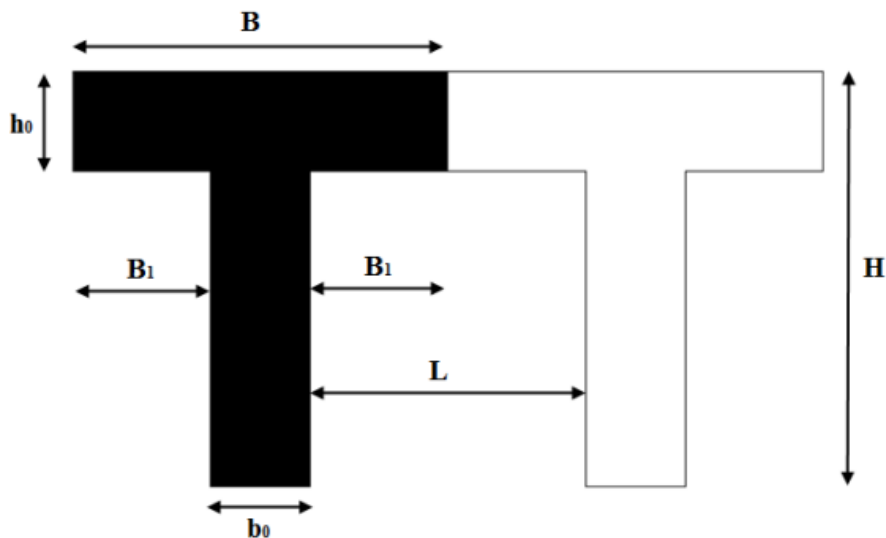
Coupe et dimension d'une poutrelle (section en T).
